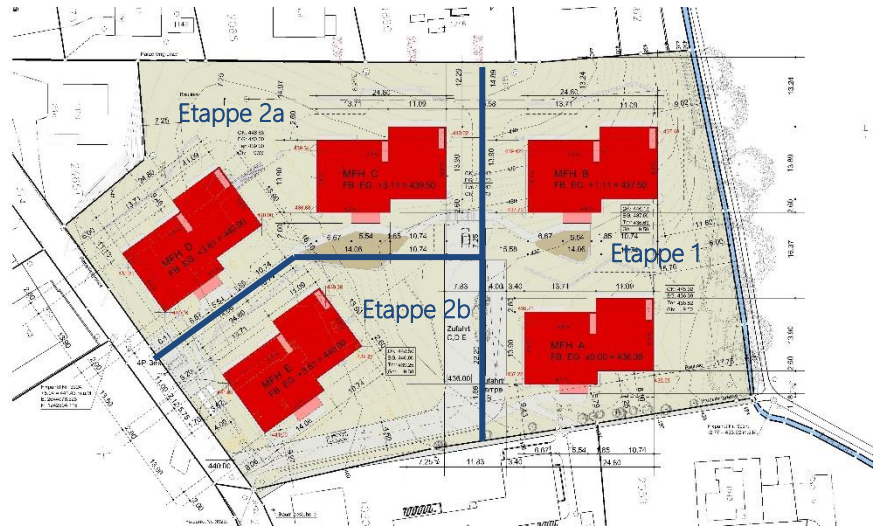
Etappierungsplan (Norden ist rechts), Strebel Architektur, Zofingen
